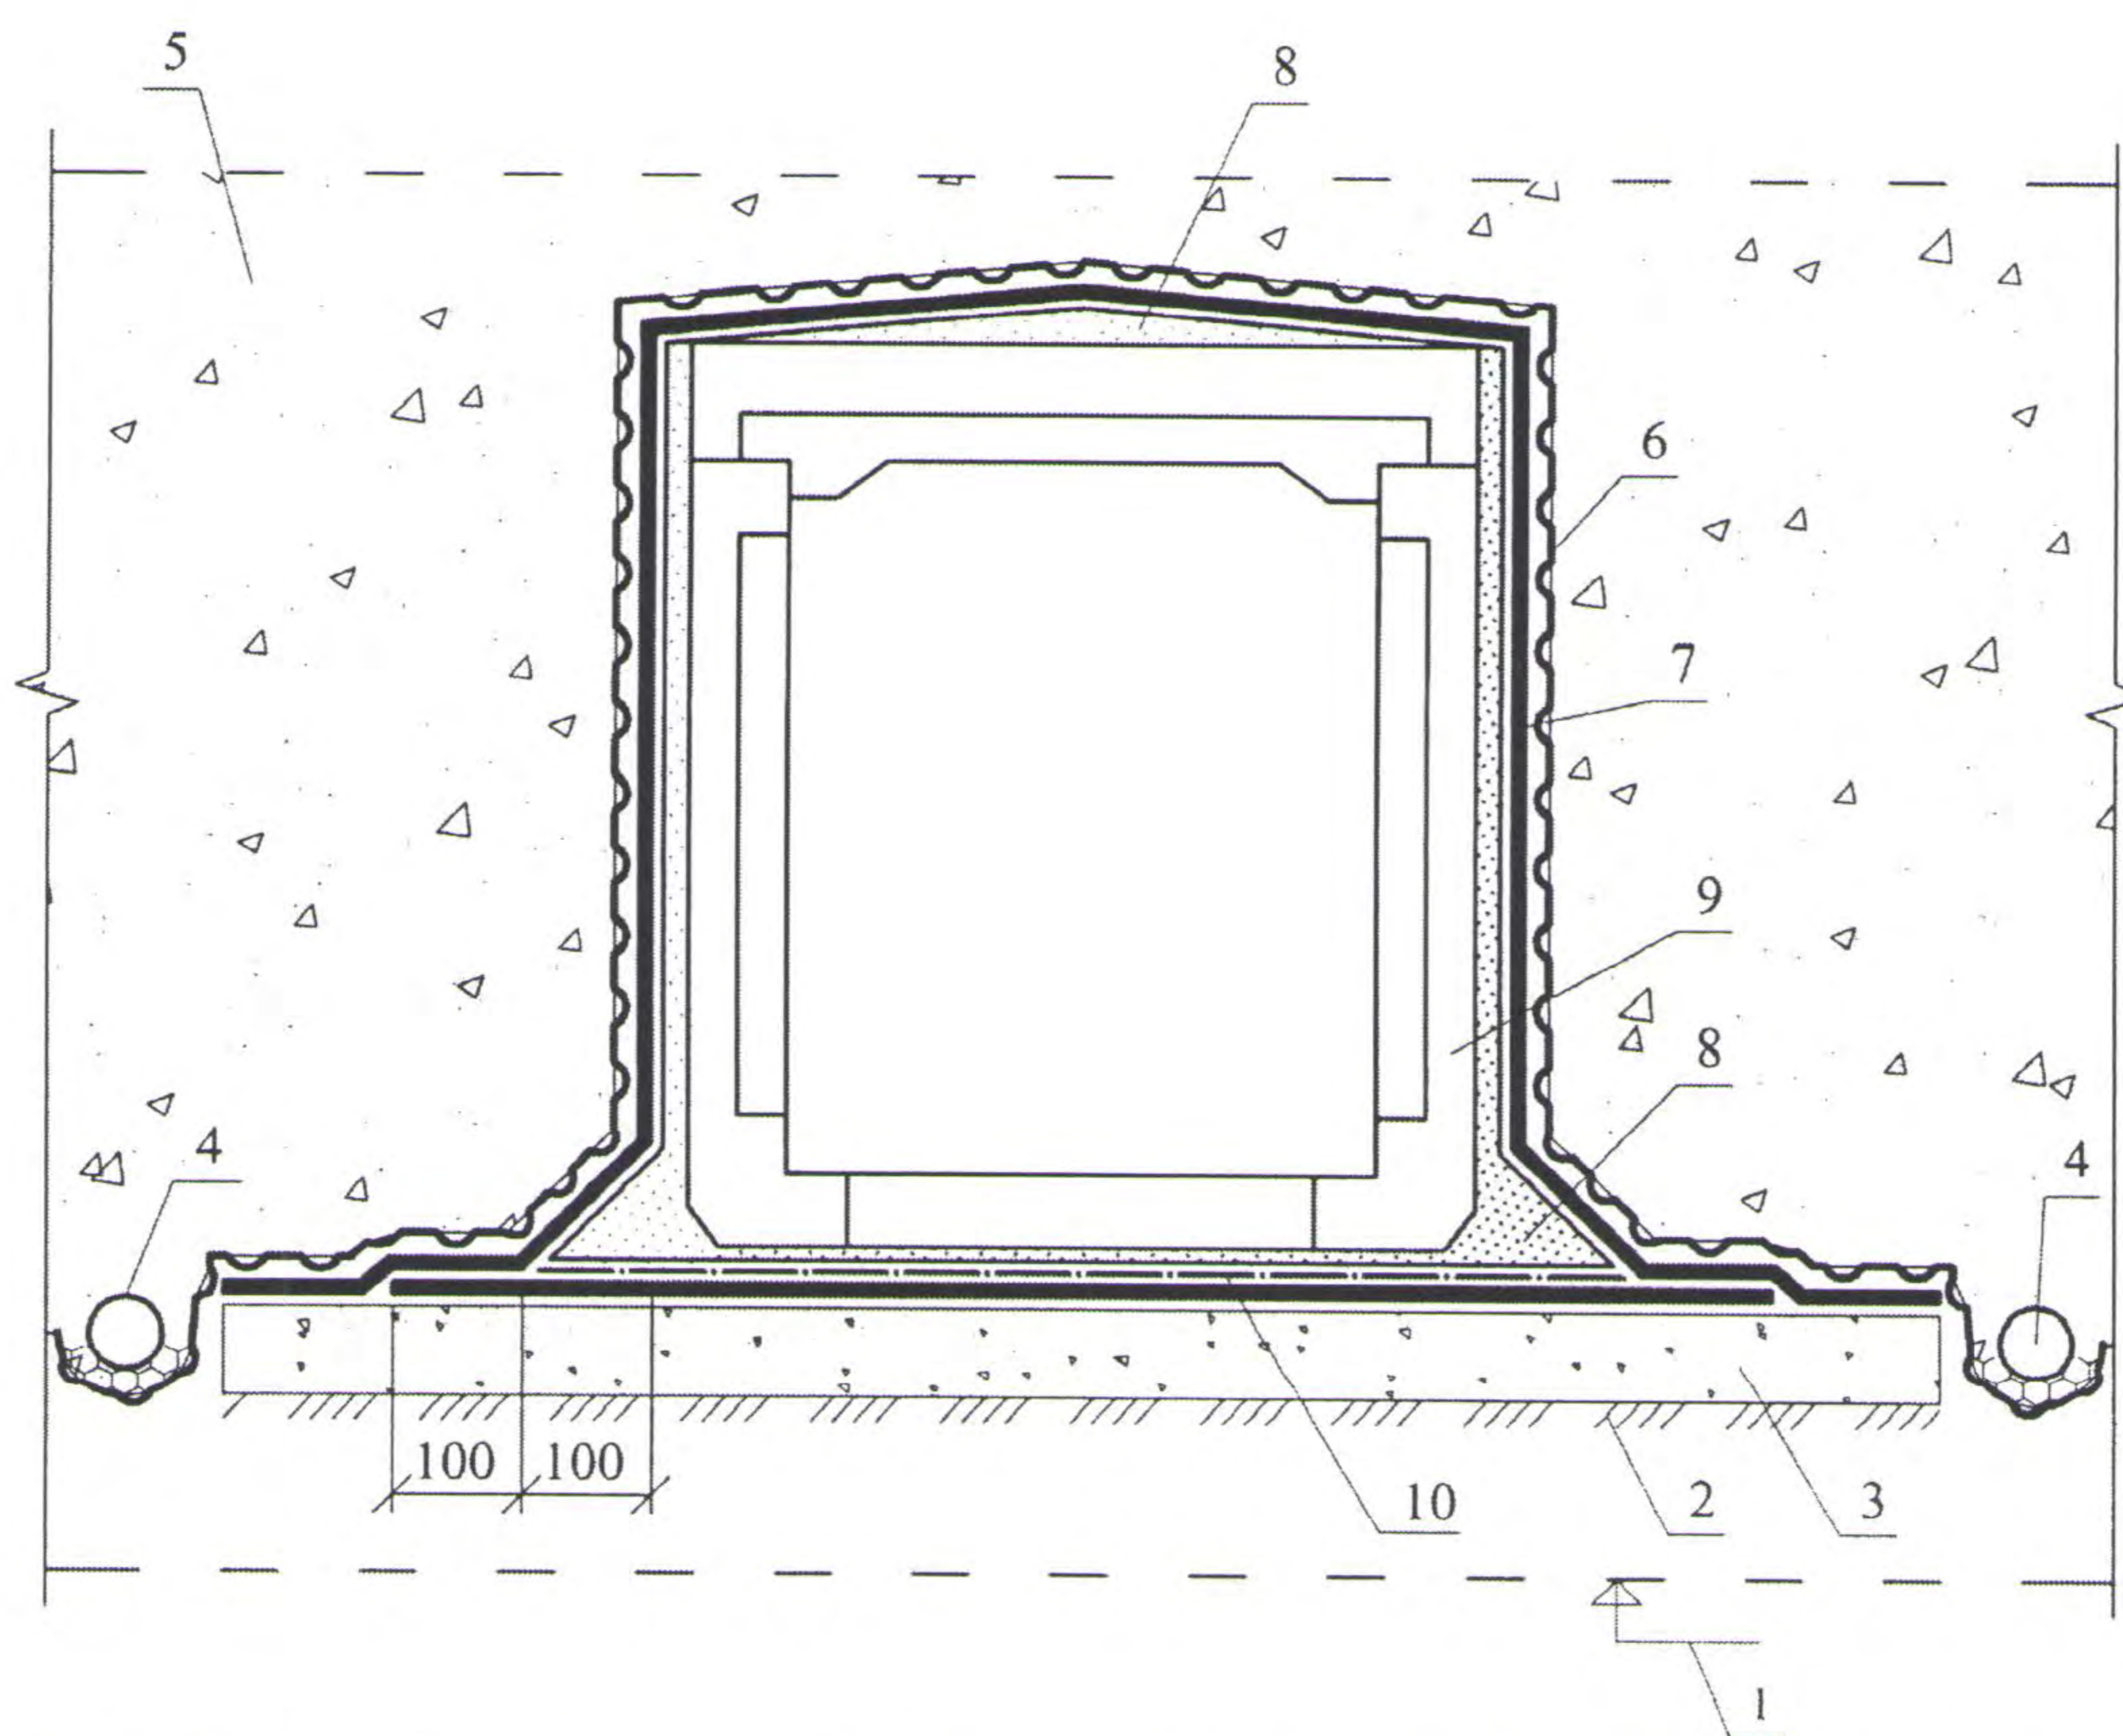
Гидроизоляция подземного сооружения от грунтовой влаги
